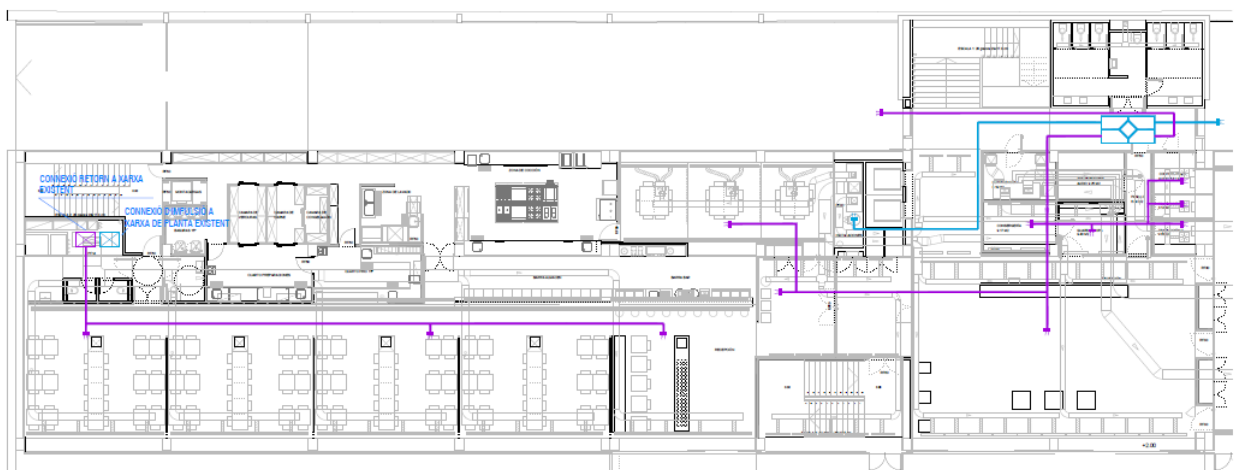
Proposta de sistema de renovació d'aire a la planta baixa, opció 1A
